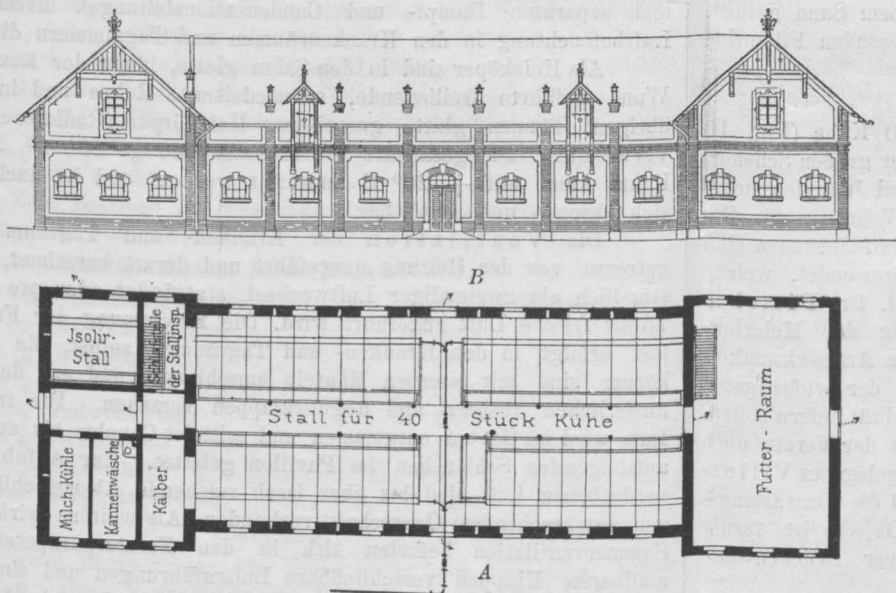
Ansicht und Grundriss des Rinderstalles.
